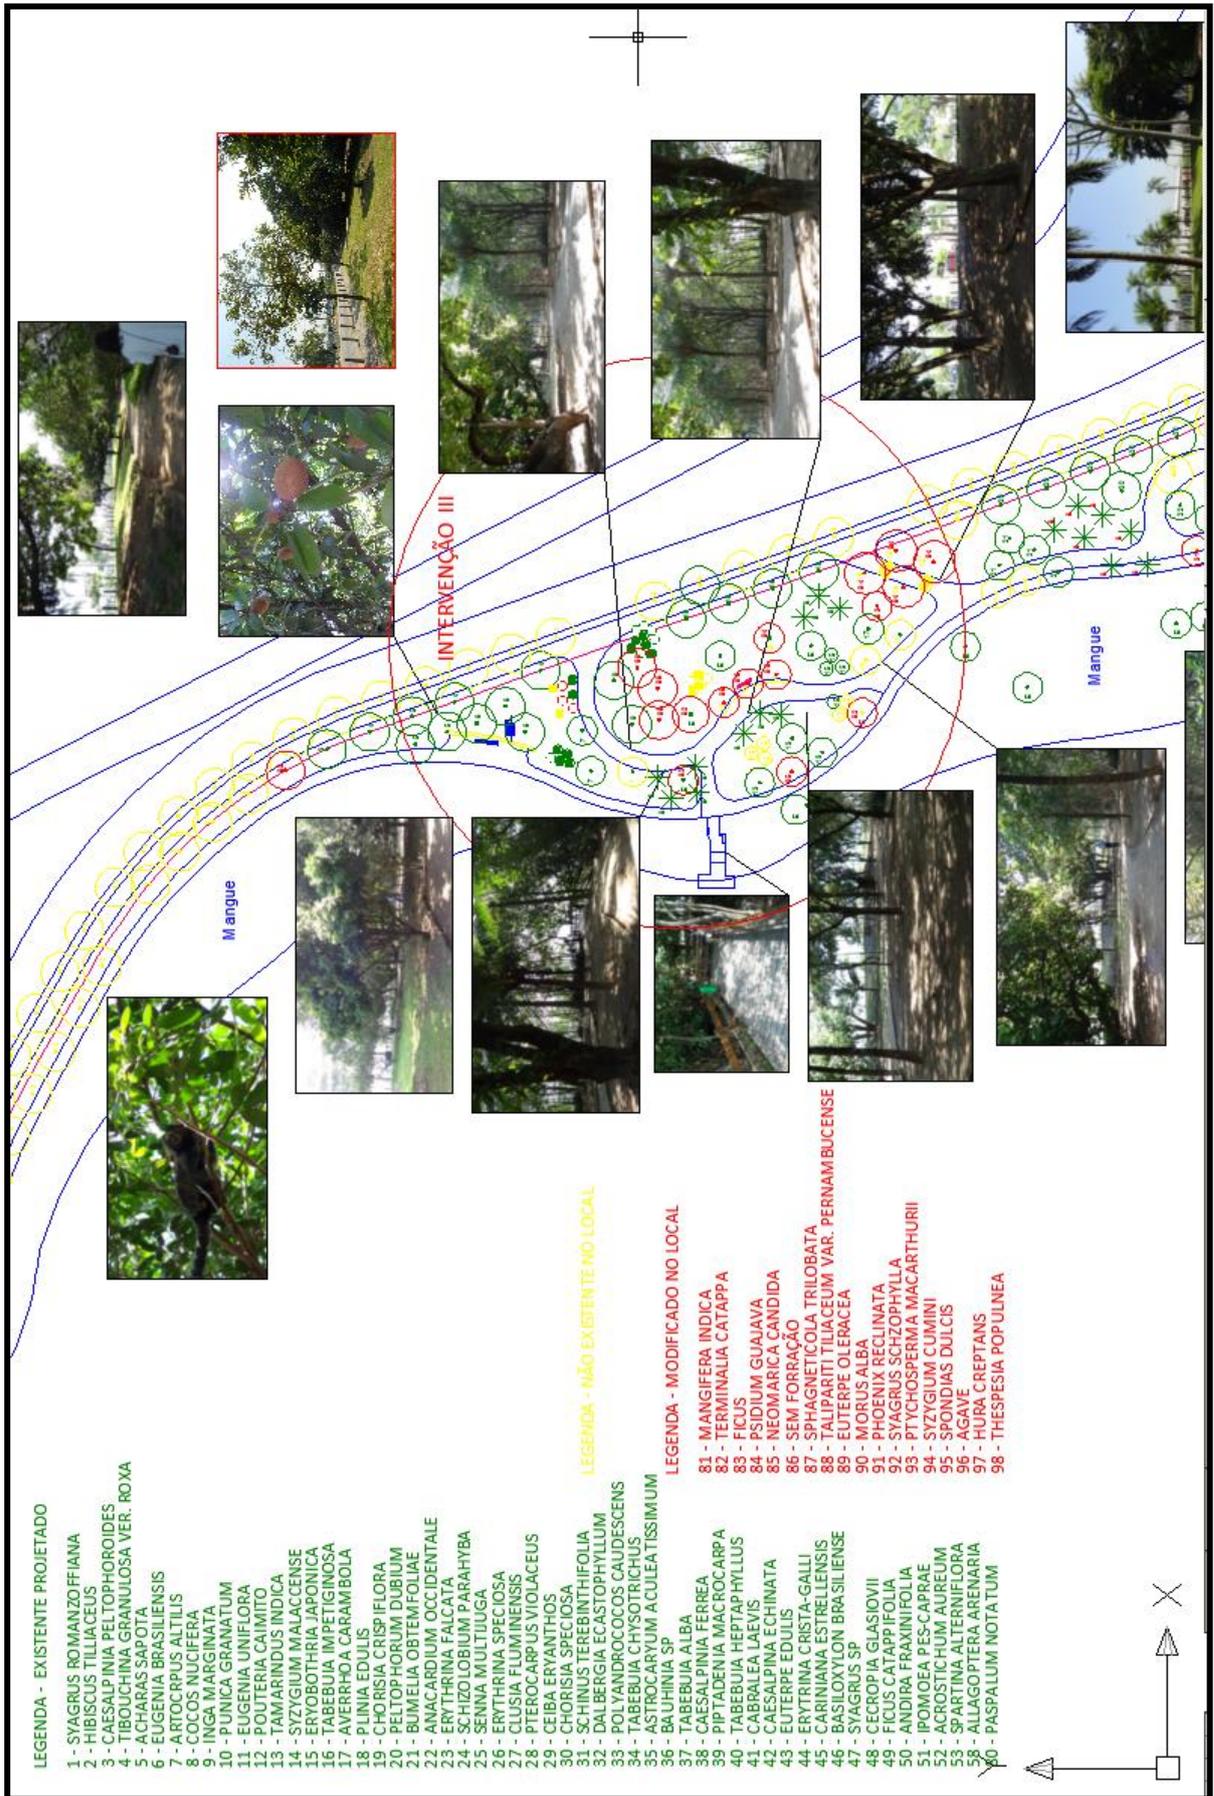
/ Prancha 04 – Planta de Levantamento da Composição Paisagística – Arborização - autora
